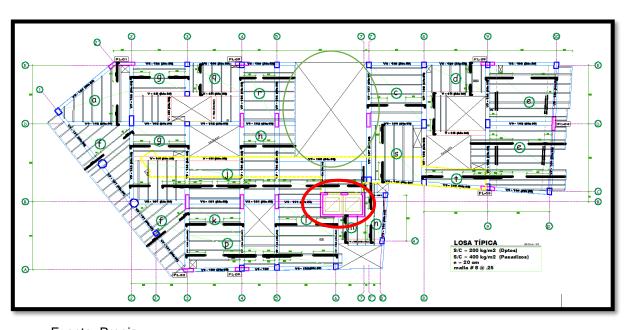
Planta Típica de una Edificación que tiene viguetas prefabricadas.
